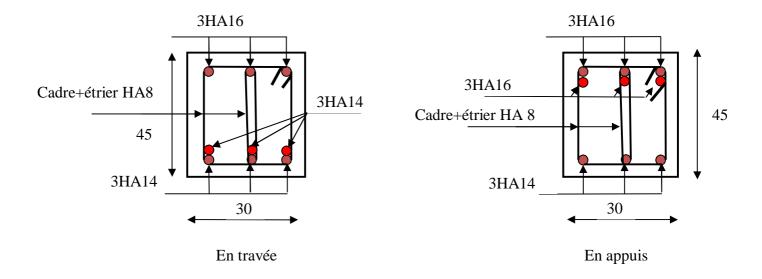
Schéma de ferraillage de la poutre principale RDC+SP.
